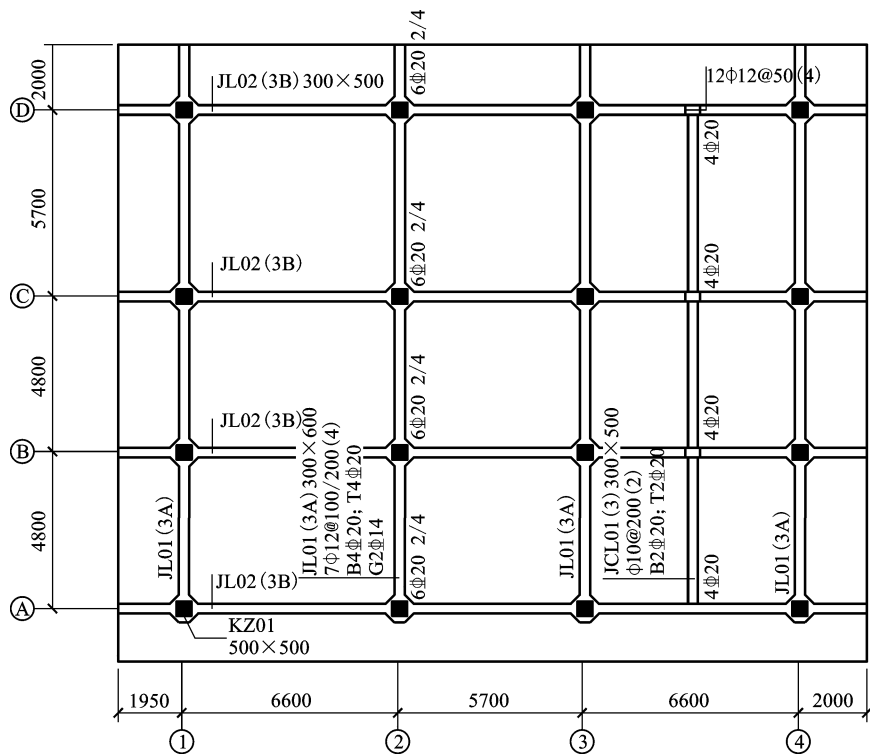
梁板式筏形基础基础主梁、基础次梁平法施工示意图
